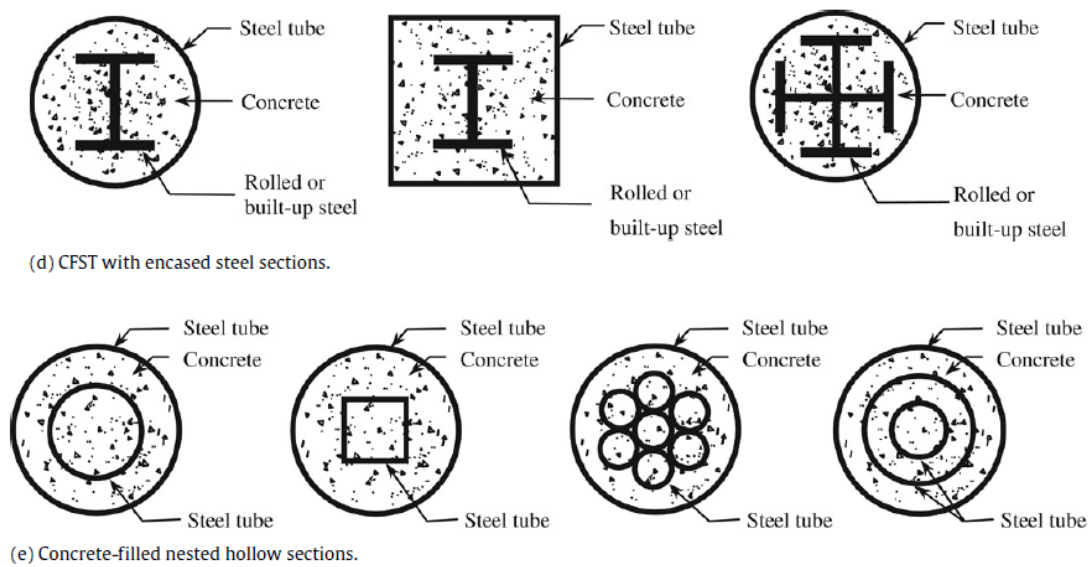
(d) Secciones tipo CFST con perfil recubierto de acero relleno de concreto y perfil embebido, (e) secciones anidadas rellenas de concreto. Fuente: Tomado de referencias (Yang, Lam, & Gardner, 2008). Pág. 3773.
